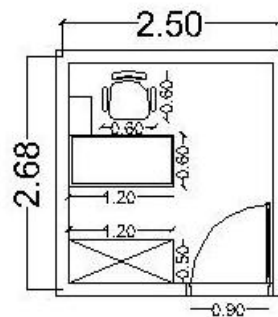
Studi Ruang Kamar Tamu Tipe *Junior Suite Room
